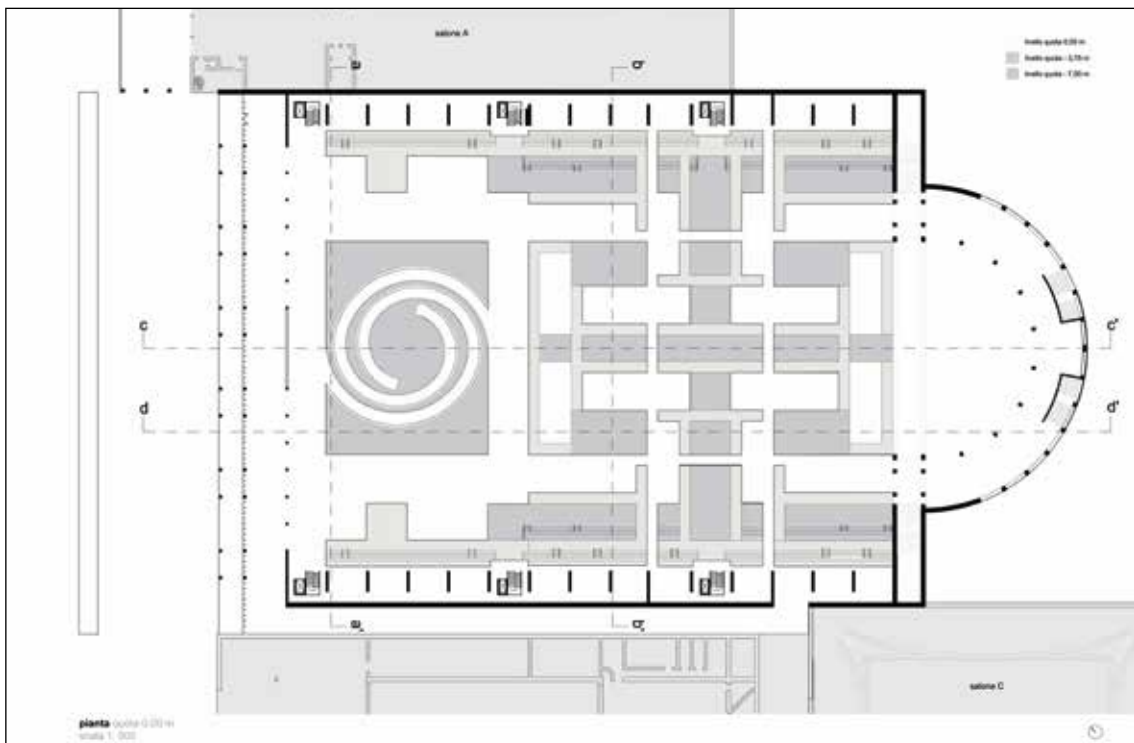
Progetto di Sarah Becchio: pianta del piano terra con le corti ricavate al livello interrato.
